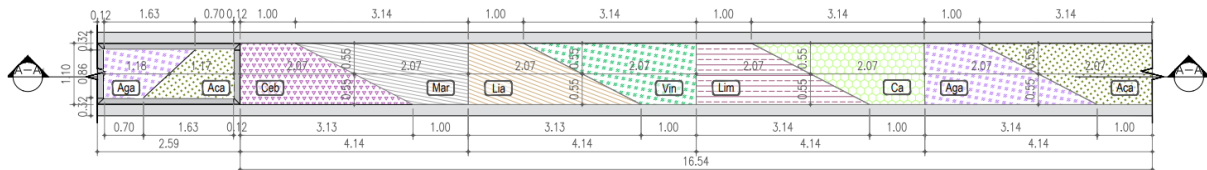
Planta detalle franja de paisajismo y mobiliario exposición plena
